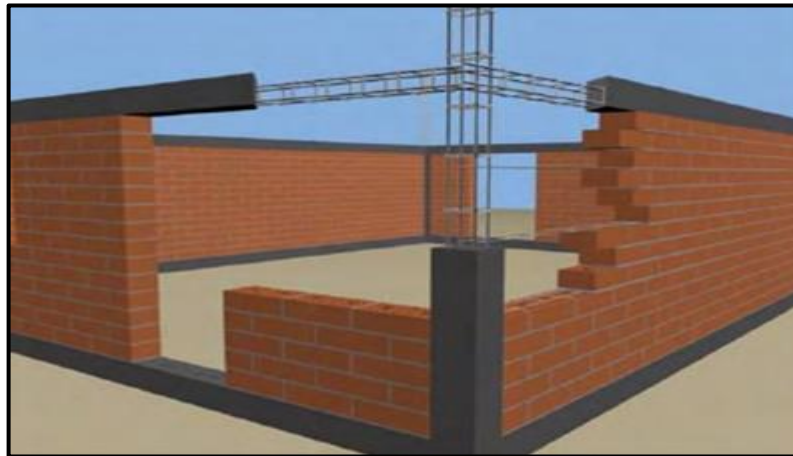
Albañilería confinada. Fuente: ConstruAprende.
